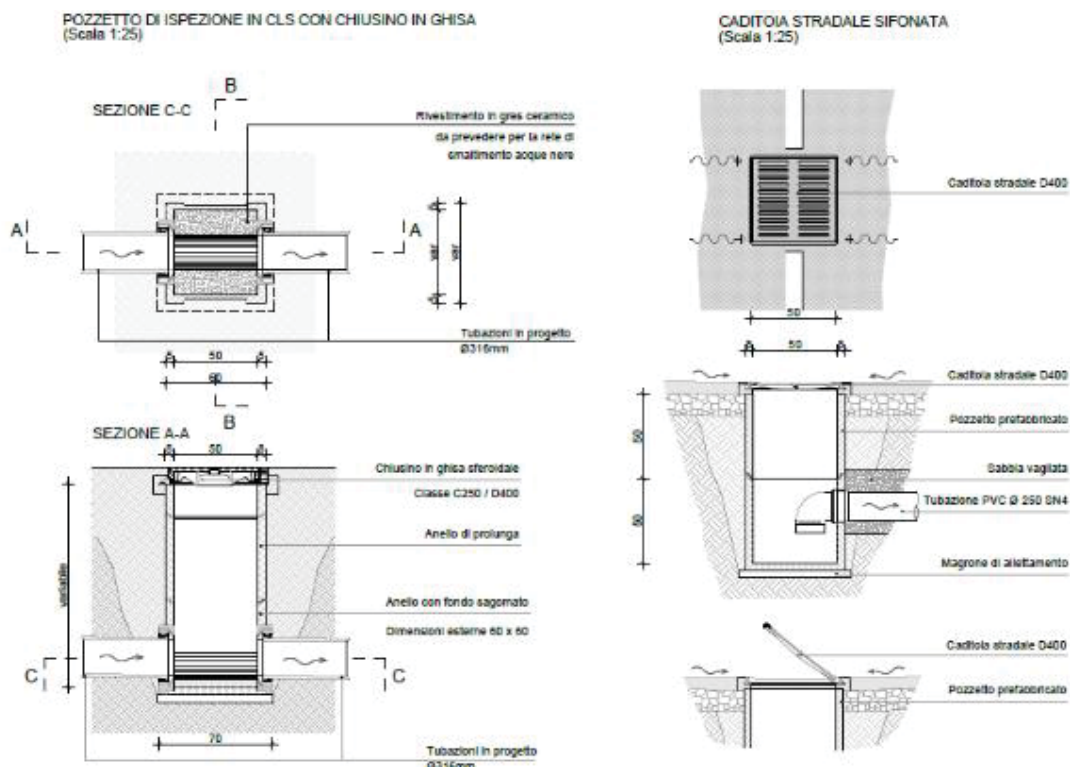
pianta e sezione schematica del pozzetto di ispezione e caditoia (opera tipo)
